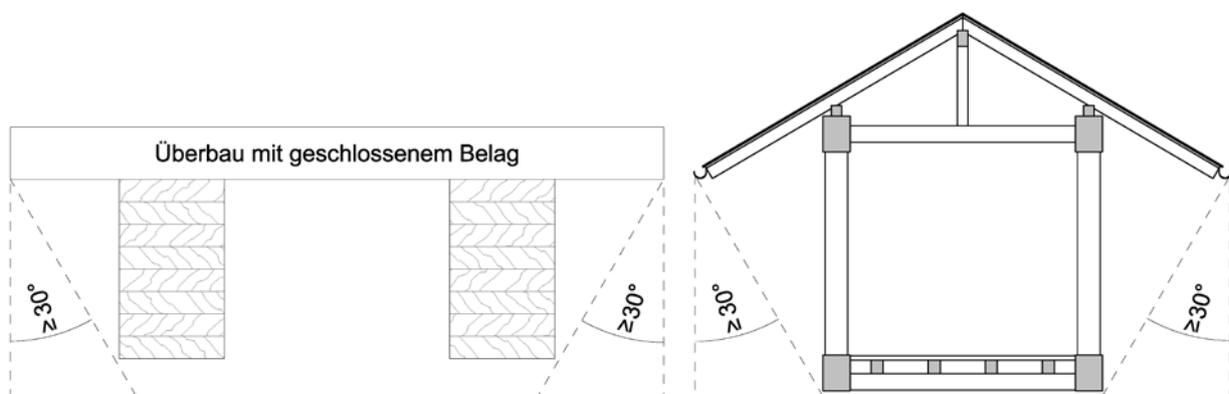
Definition eines Überstandes mit schützender Wirkung für die darunter liegende Konstruktion (li.: Deckbrücke; re.: Fachwerkbrücke)
